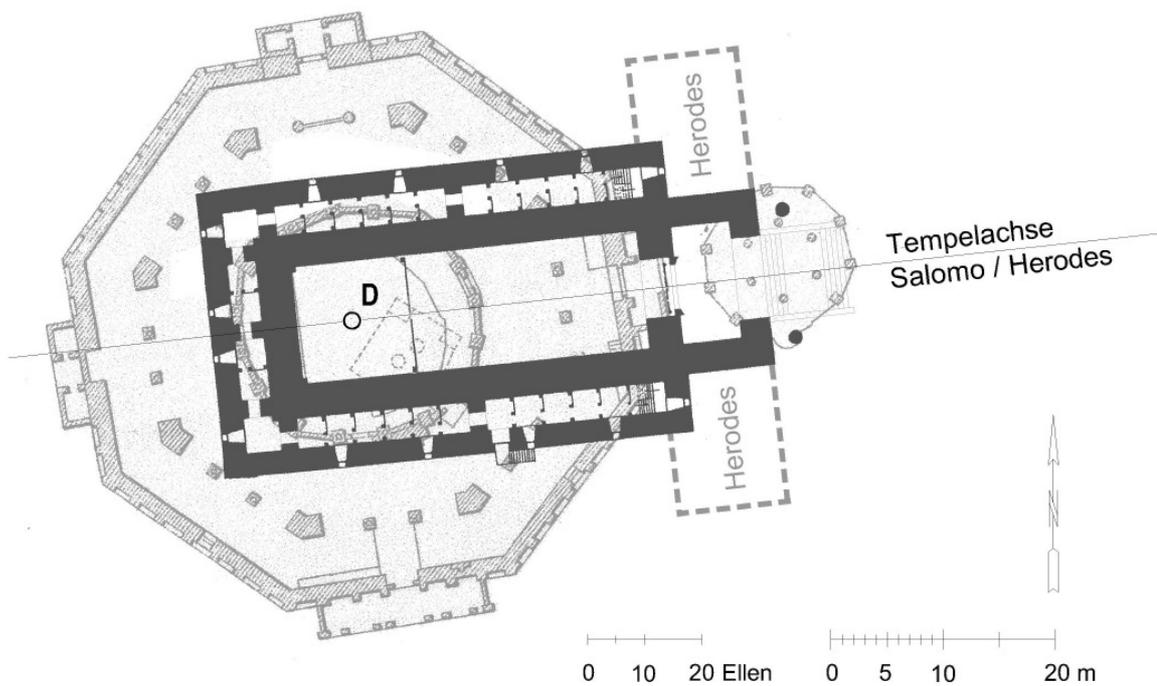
Lage des Tempels (Rekonstruktion) in Beziehung zum Grundriss des Felsendoms
